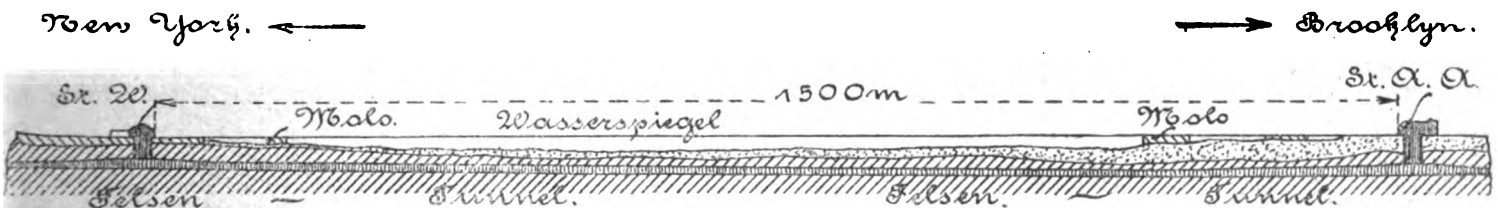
Längenschnitt des Tunnels für eine elektrische Eisenbahn unter der Stadt New-York.
